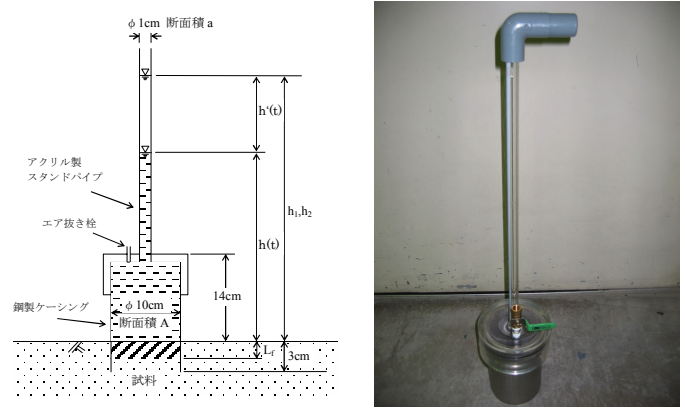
現位置変水位透水試験 写真-2 簡易現場透水試験器
